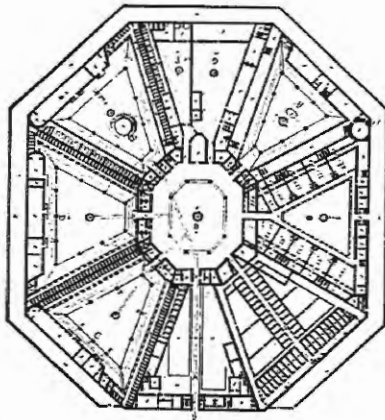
Planta Completa da Prisão de Ghent – Bélgica.
